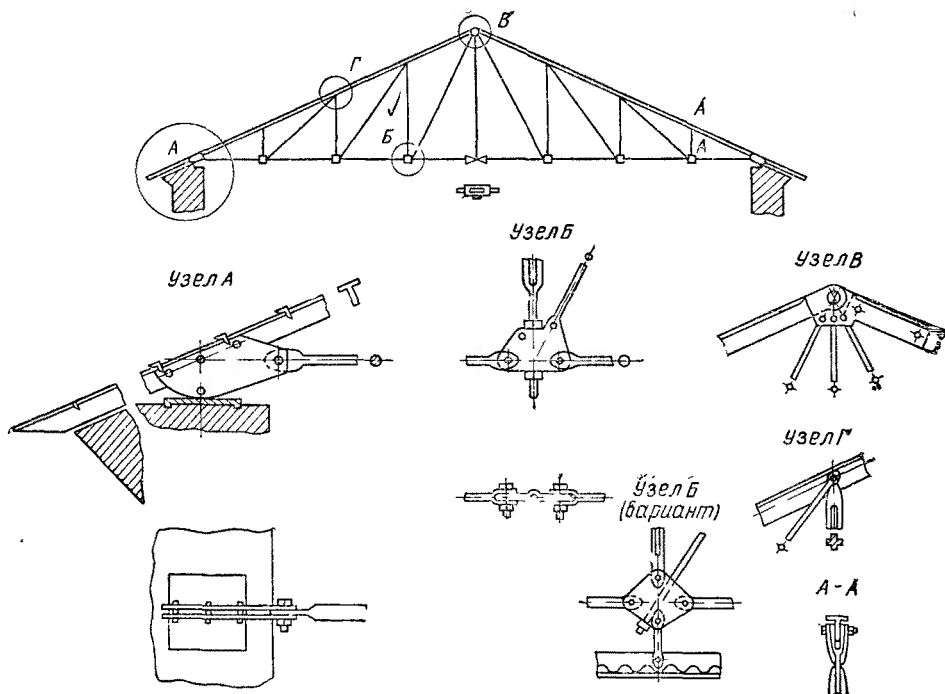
Скропальная ферма (70-е годы XIX в.)
